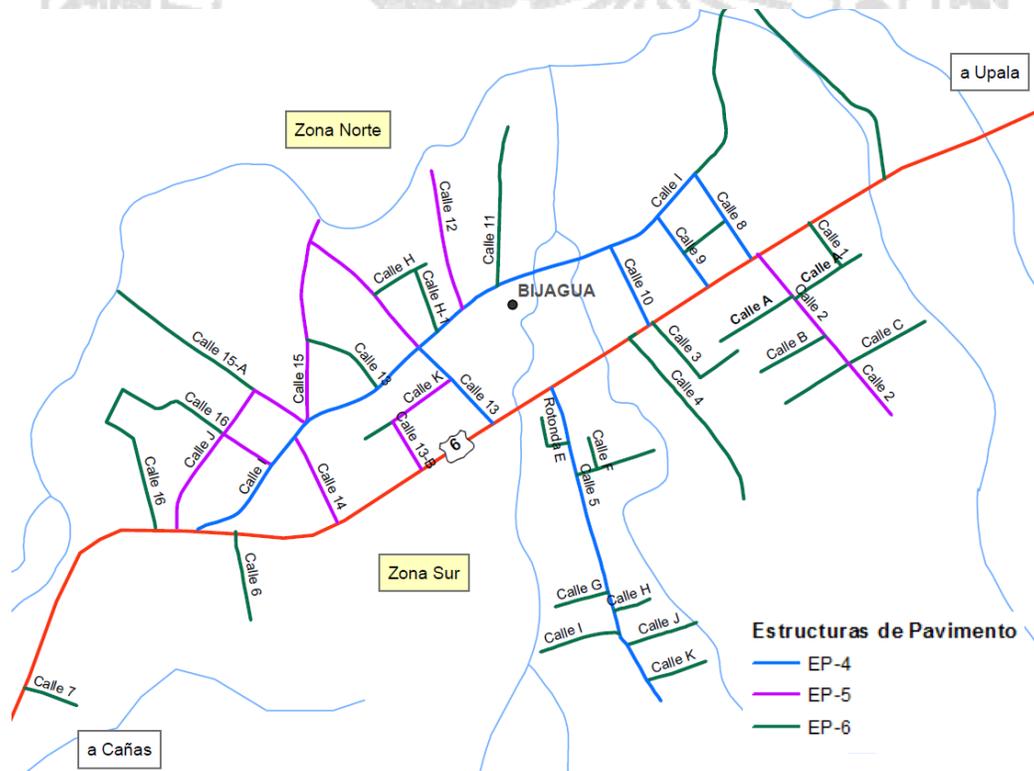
Estructuras de pavimento semirrígido (Opción 2).
